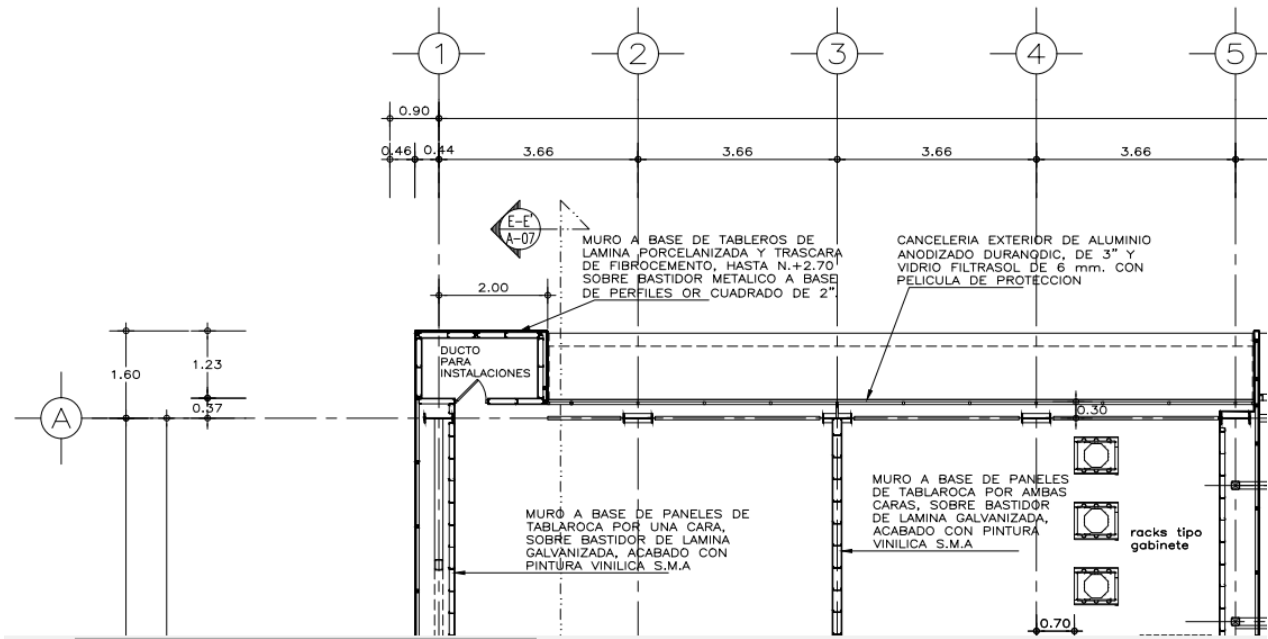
Detalle planta baja arquitectónica. Elaborada por el autor
